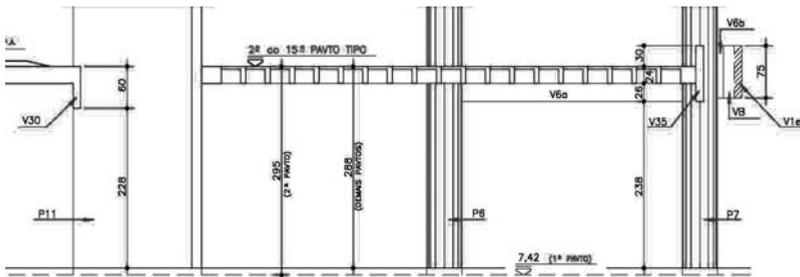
Corte do projeto estrutural do pavimento tipo.
